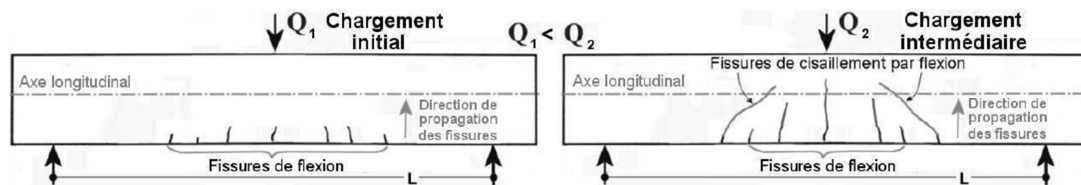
II.1: Représentation de la fissuration initiale et intermédiaire par flexion d'une poutre en béton armé (BA). [8]
